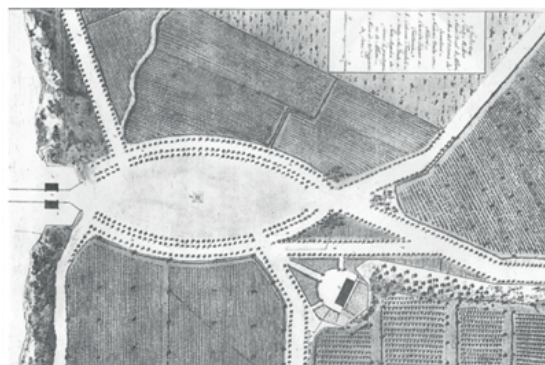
(right) Giuseppe Valadier, Planimetria della sistemazione della Piazza di Ponte Milvio, 1805;
